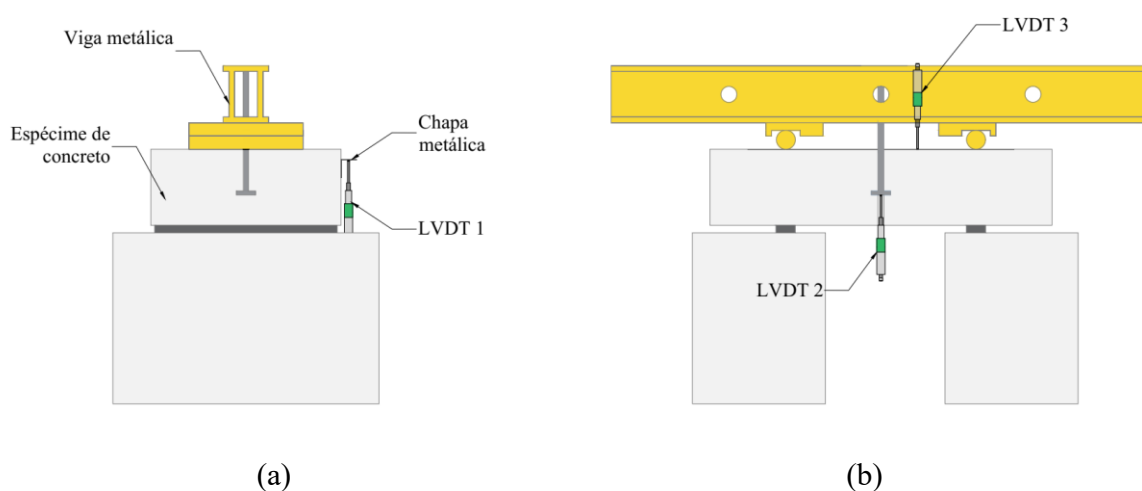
Disposição dos LVDT's para leitura de deslocamento: a) Vista lateral do sistema de ensaio; b) Vista frontal do sistema de ensaio.
